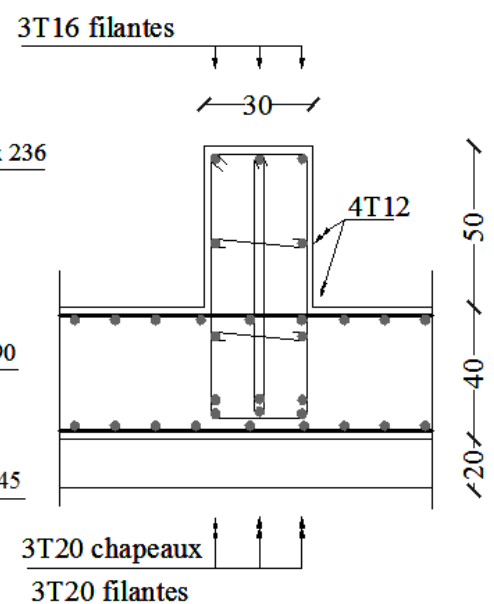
schéma de ferrailage des poutres secondaires
